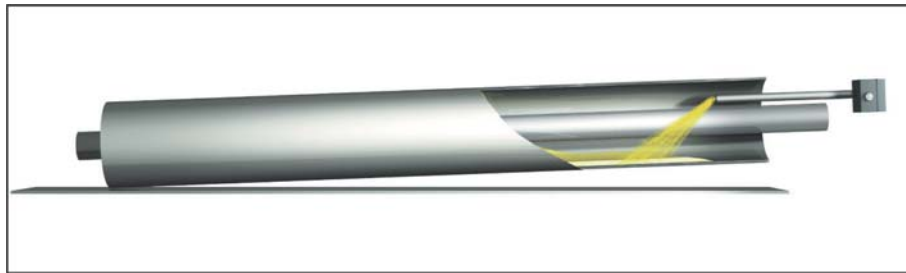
Wirtschaftliches Dämmen jedes beliebigen Rohrdurchmessers mit der Gießtechnik.
